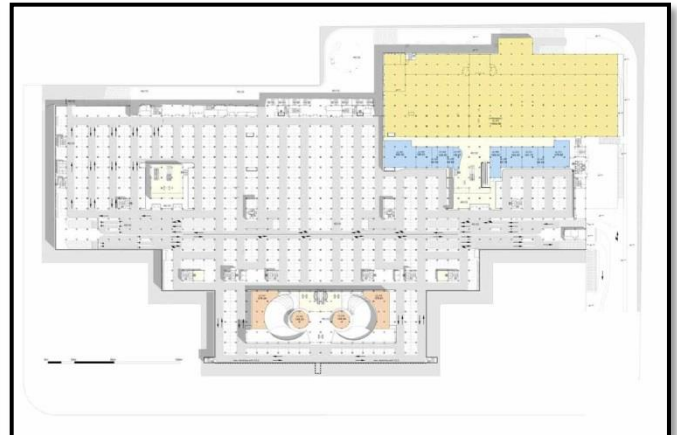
Plan du 1<sup>er</sup> sous-sol
